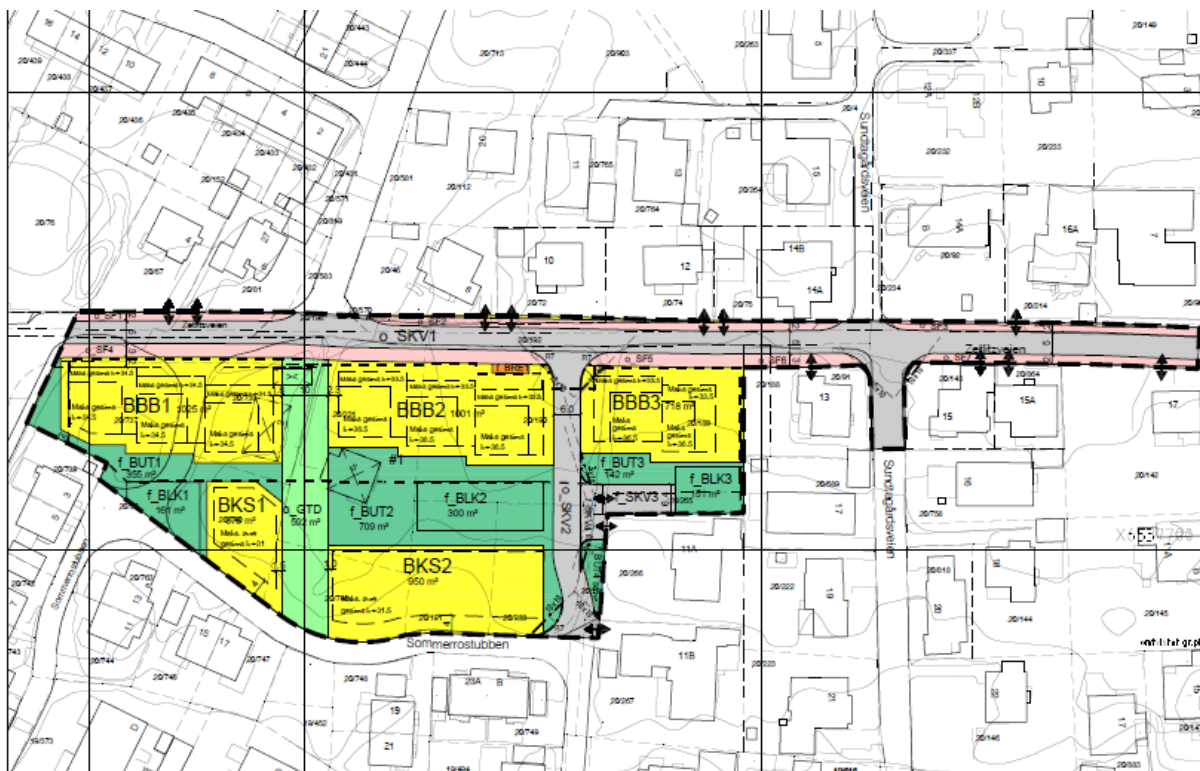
Plan 2106 for kollektivfelt/bussevei
